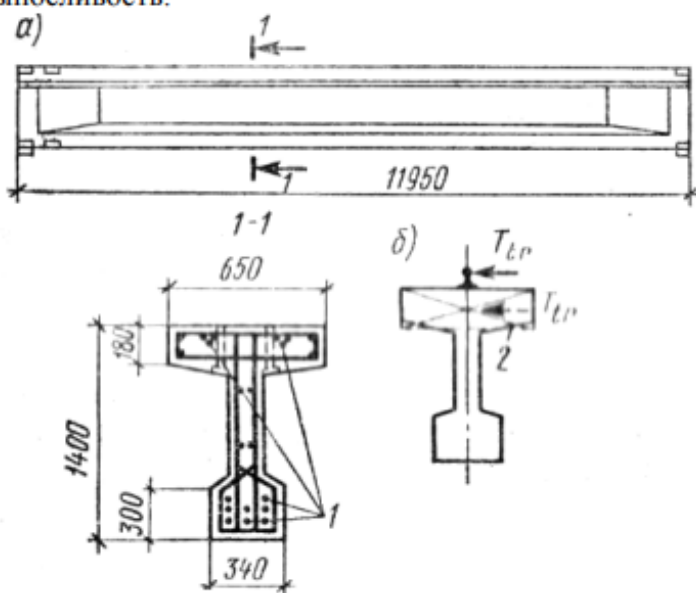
Конструкция подкрановой балки: — напрягаемая арматура; 2 — расчетное сечение.
